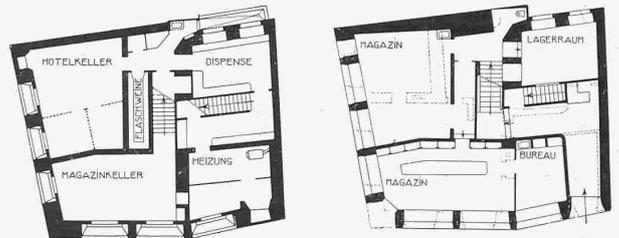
Grundrisse zum Hotel Post in Luzern. — Masstab 1 : 400.
